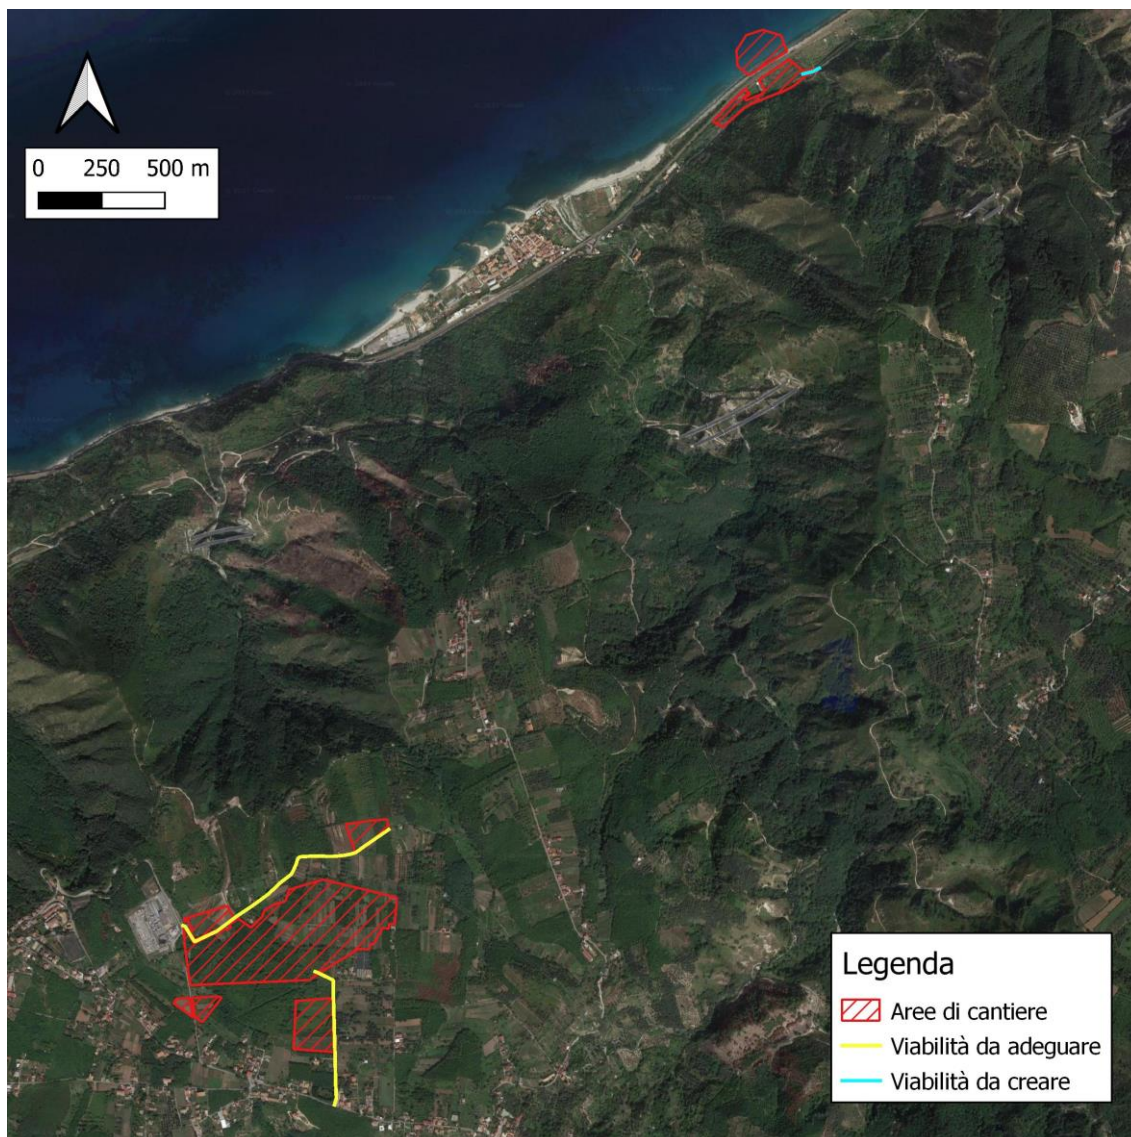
Planimetria con indicazione delle aree di cantiere e delle viabilità da adeguare e da creare
